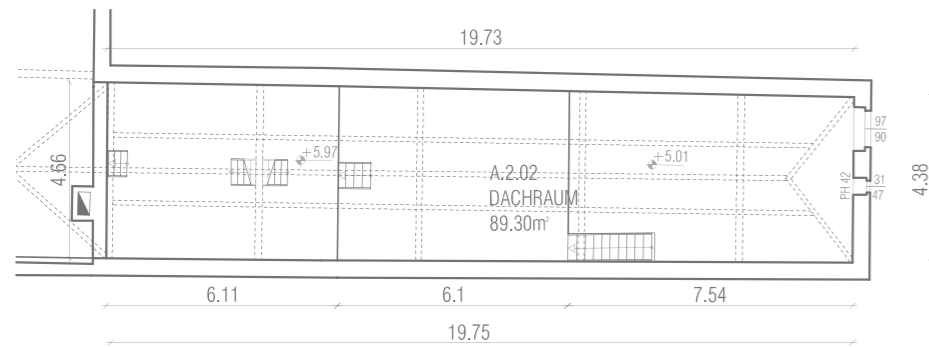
Grundriss Raum A.2.02_1:200
